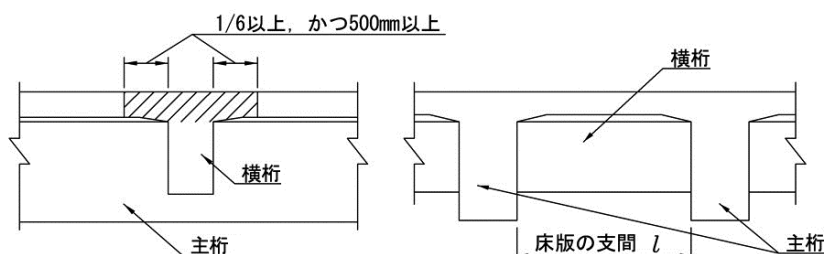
横桁上の床版の上側鋼材の配置範囲
